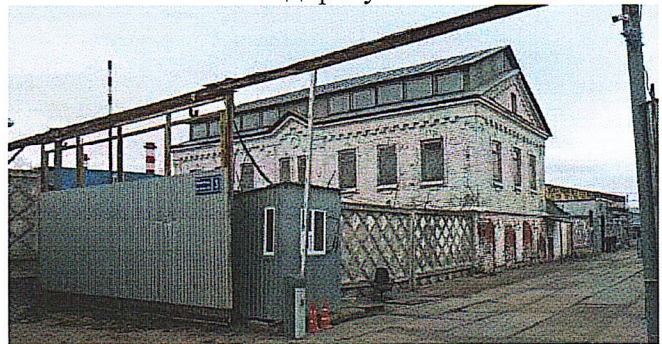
Фрагмент главного фасада и торцевого фасада, выходящий на железную дорогу
